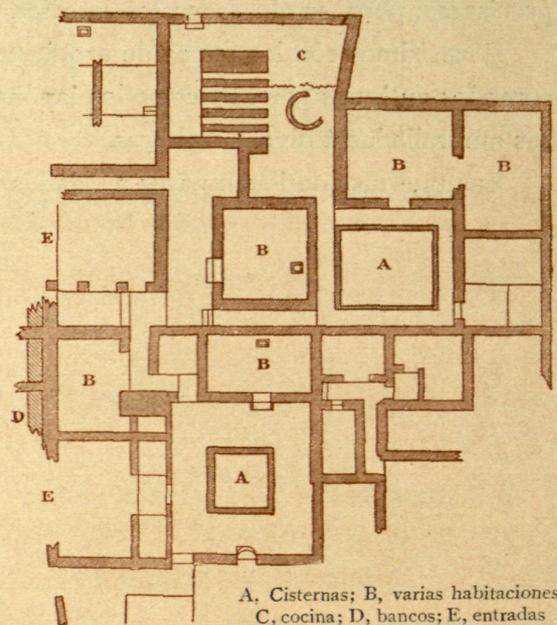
PLANTA DE UNA CASA TOLTECA DESCUBIERTA EN TULA, SEGÚN DE CHARNAY
